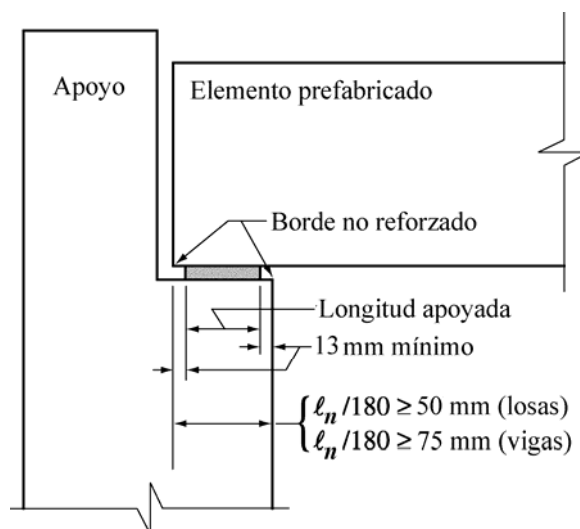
Longitud de apoyo en dinteles y repisas
